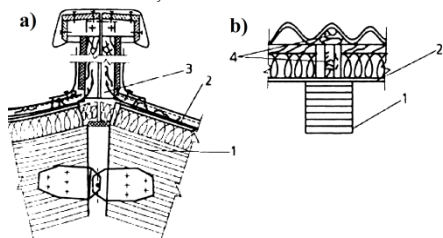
Construcția diafragmelor: a - longitudinală, b - transversală, 1 - construcția portantă a acoperișului, 2 - construcția de închidere, 3 - diafragma longitudinală, 4 - diafragma transversală.
